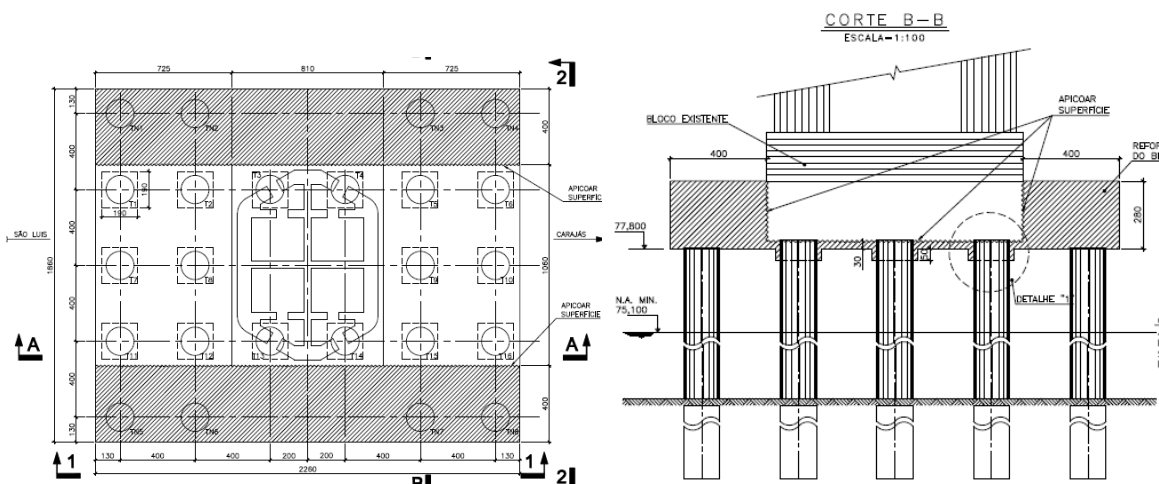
Infraestrutura – planta e corte de locação das novas estacas e prolongamentos do bloco.
